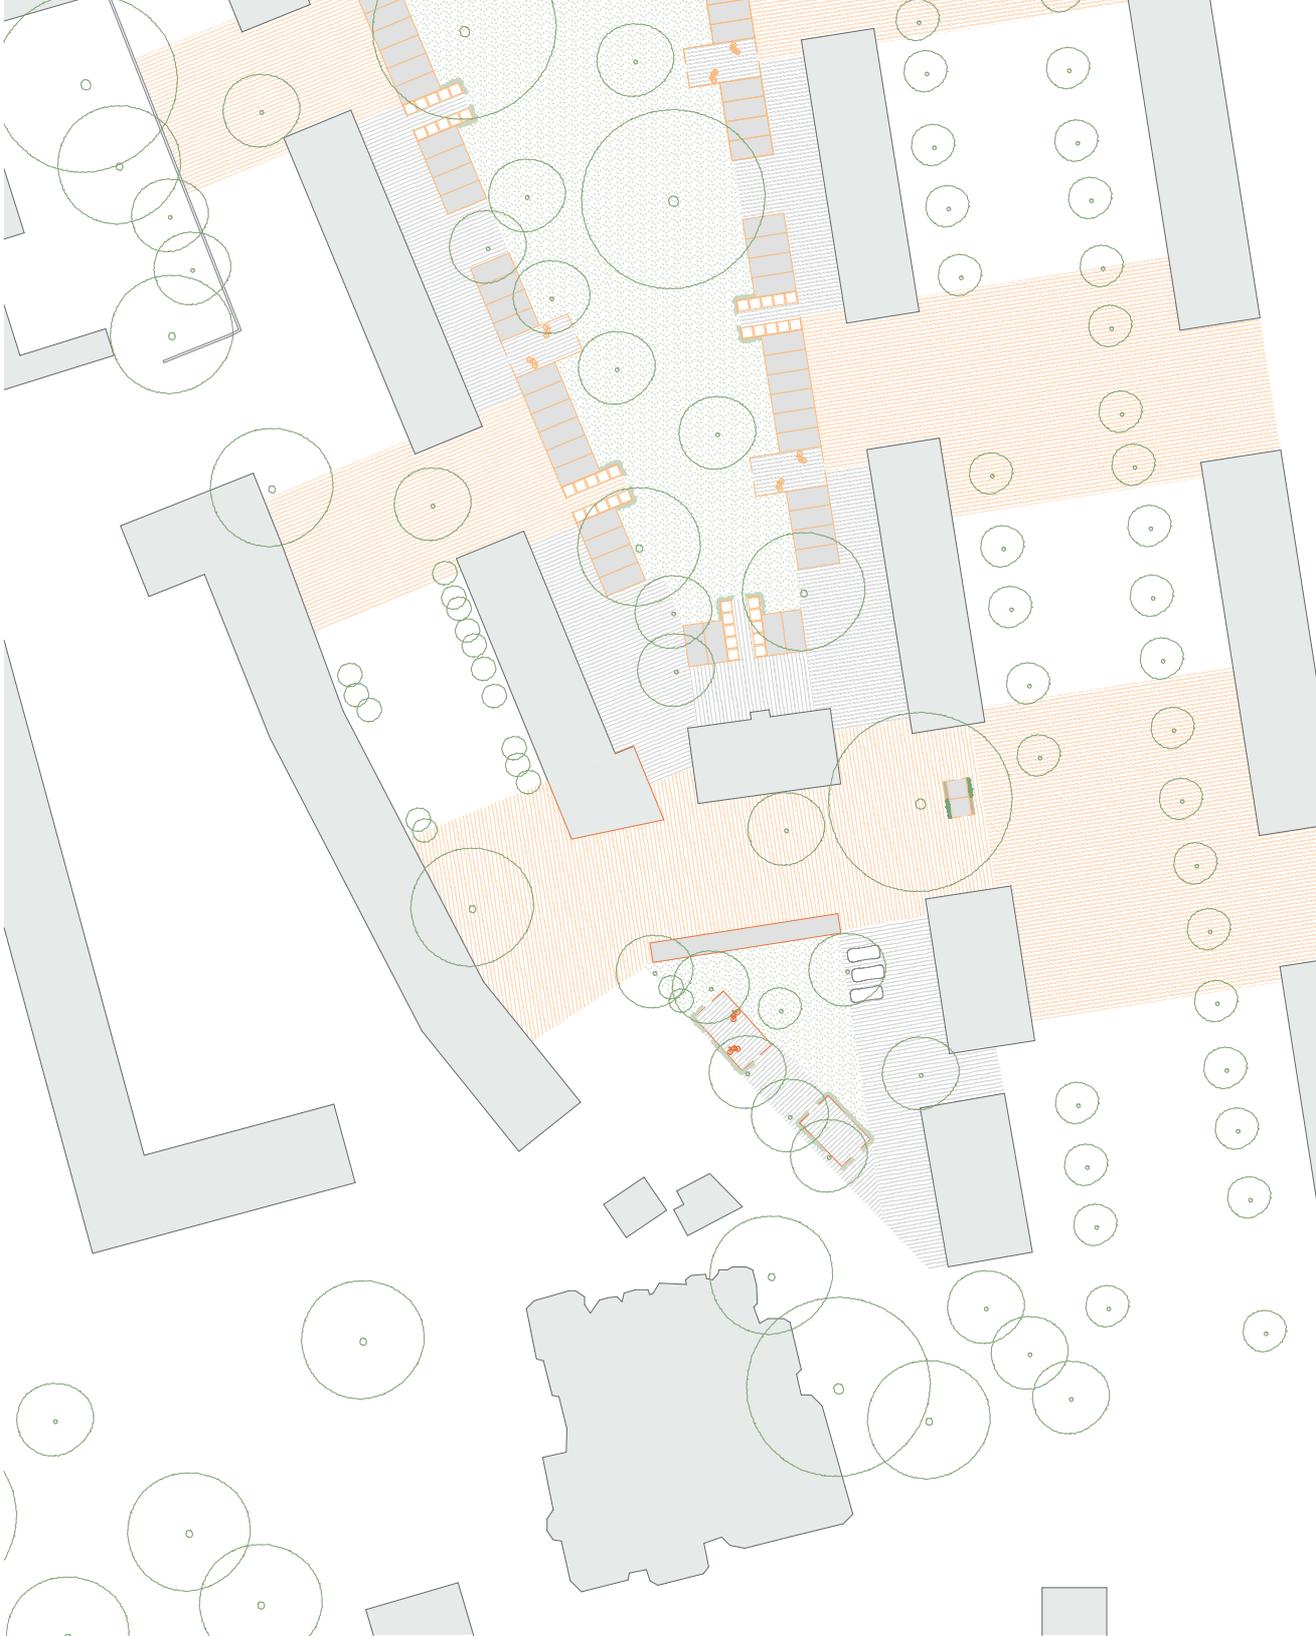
Grundriss beliebter belebter Bauernmarkt
